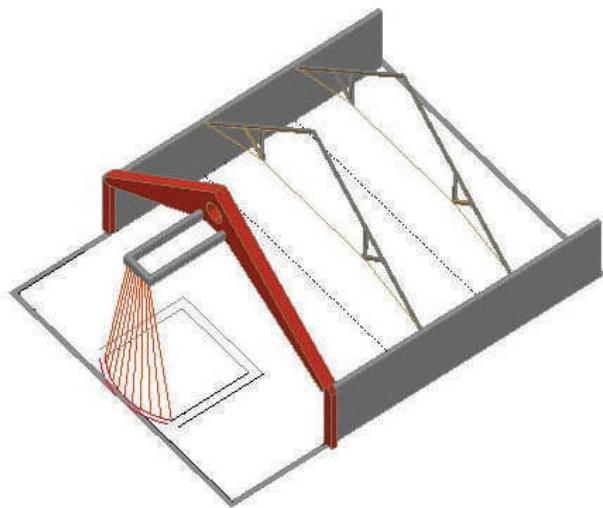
ETAPA 1 – Após as fundações, faz-se a viga triangular e seus pilares. Logo se faz a parede do abside. Esta parede é de duplo tijolo com armaduras guias no meio, o anel intermédio se faz à continuação, estará apoiado na parede e na viga triangular que deixou armaduras de espera. Este anel receberá armaduras da parede – cobertura. (*-5).
